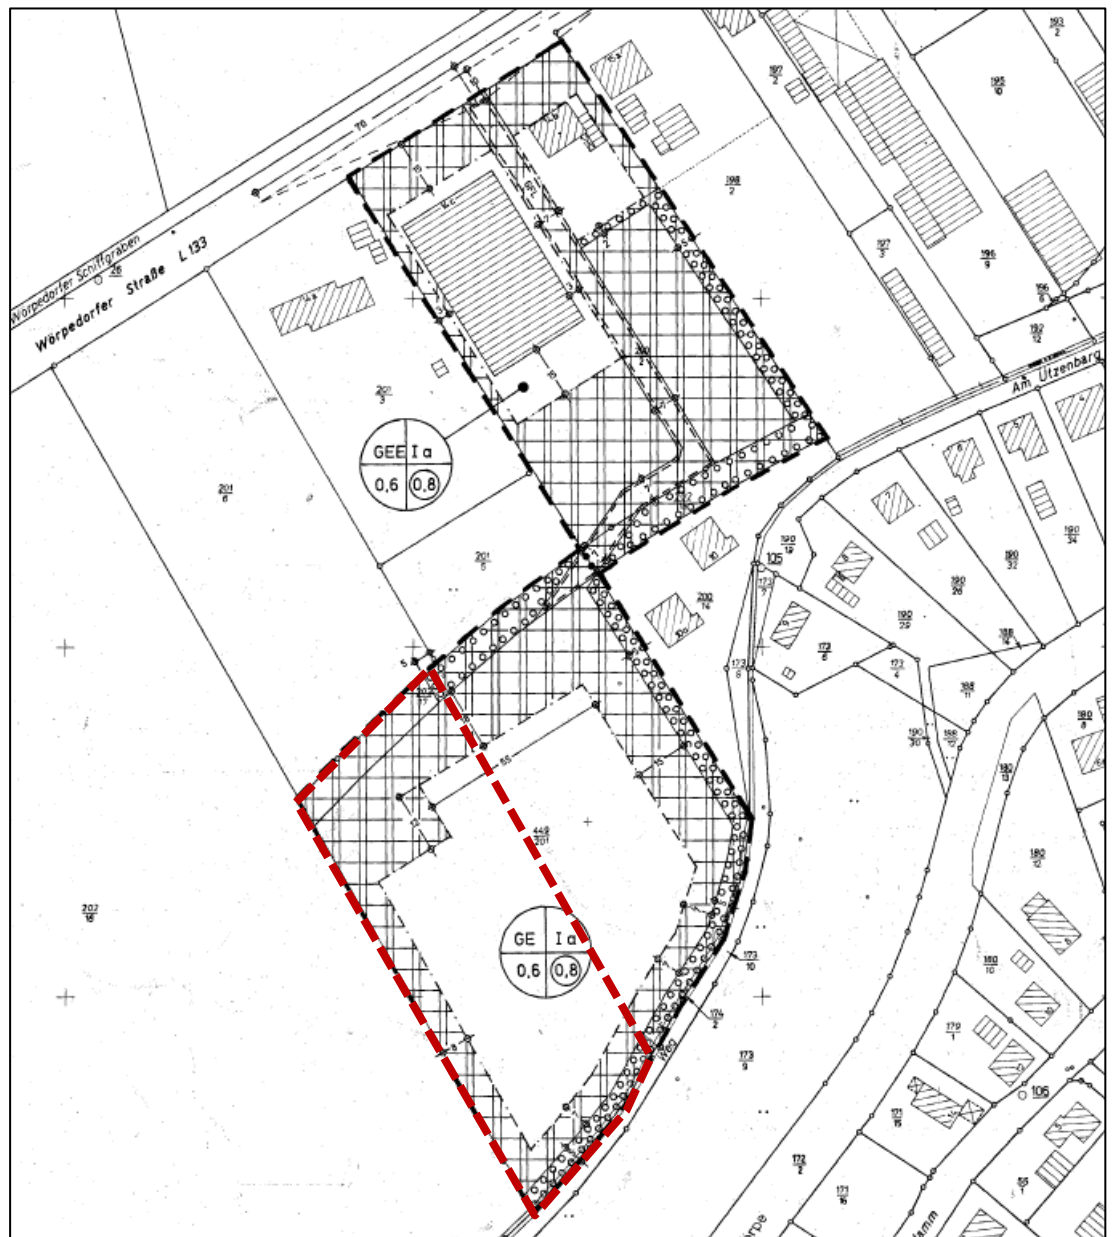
Bebauungsplan Nr. 14, 1. vereinfachte Änderung (der durch den Bebauungsplan Nr. 51 überplante Bereich ist rot markiert)
